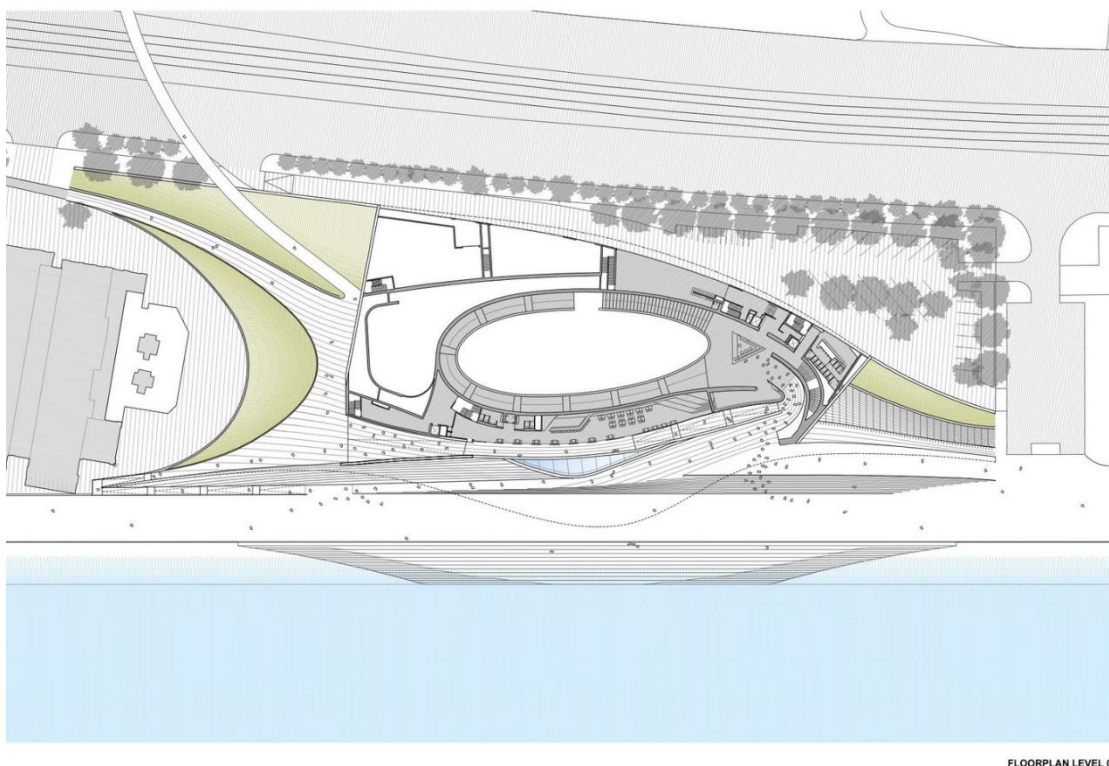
Planta do primeiro piso do MAAT, Lisboa.
